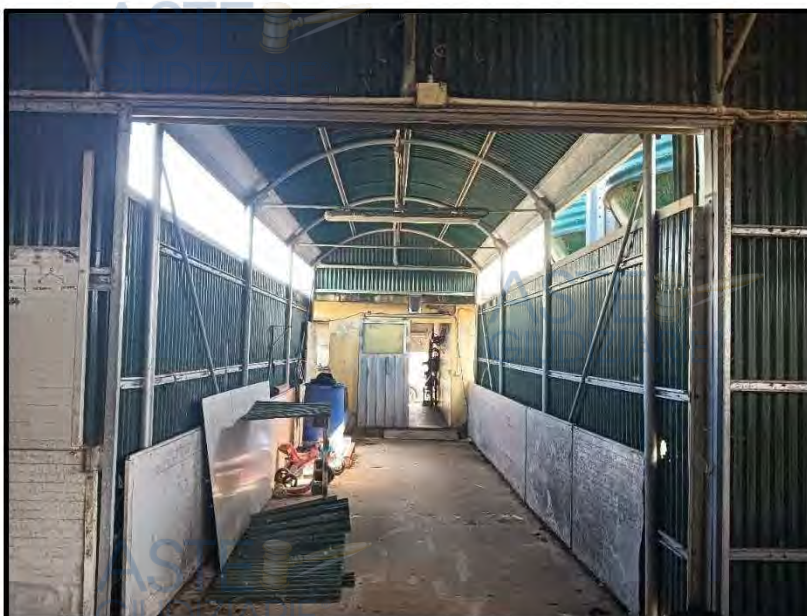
Tunnel di collegamento tra il capannone e la sala mungitura
